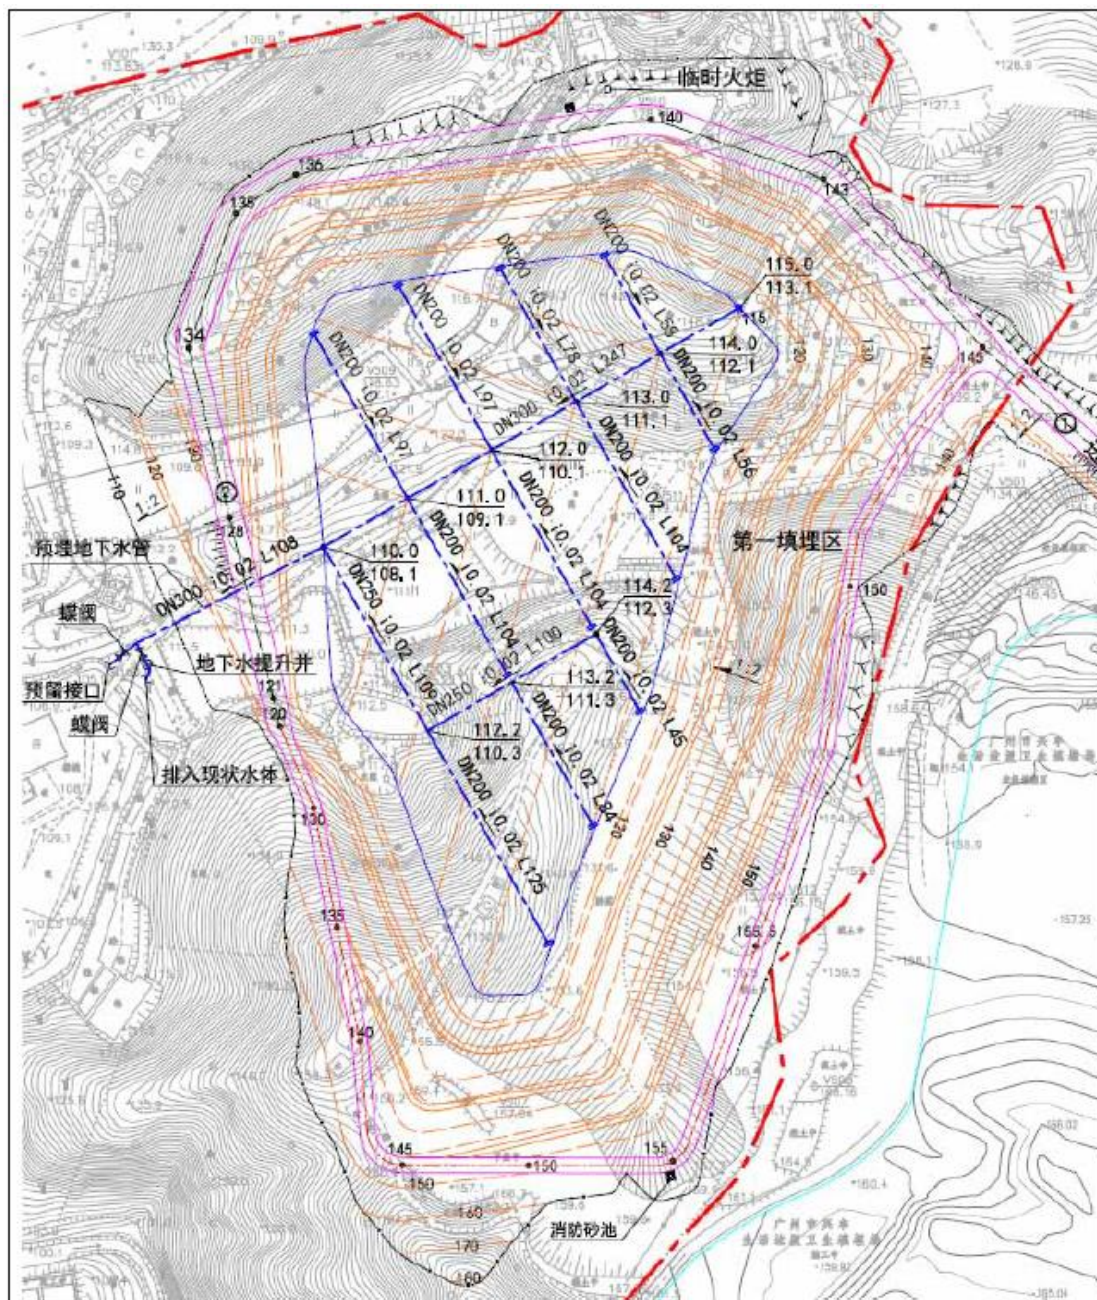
第一填埋区建设地下水收集和导排系统平面图
